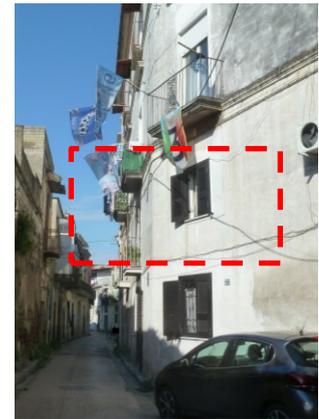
SUB 104: affacci del piano ammezzato sulla strada;
